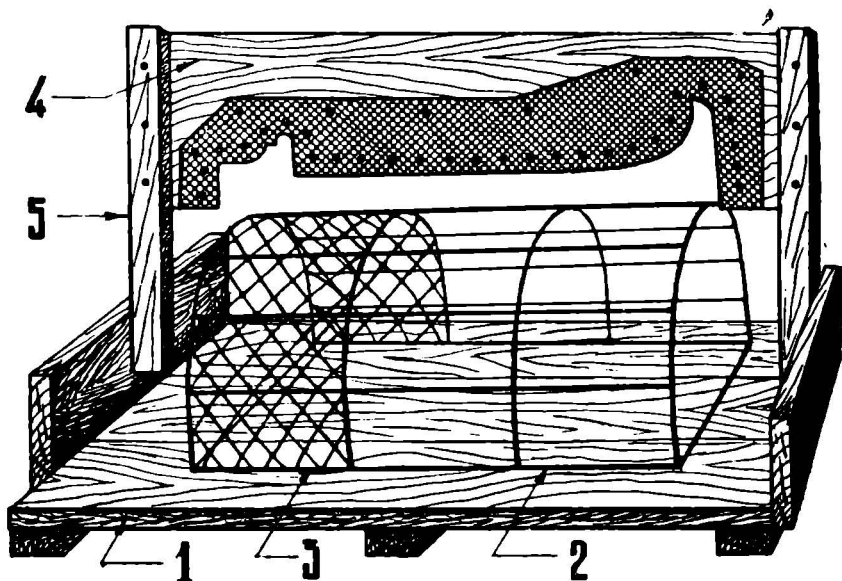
Схема крепления тела капители к щиту и установка шаблона. 1 — щит, 2 — металлический каркас, 3 — проволочная сетка, 4 — шаблон, 5 — рейки, соединяющие шаблон с осью
